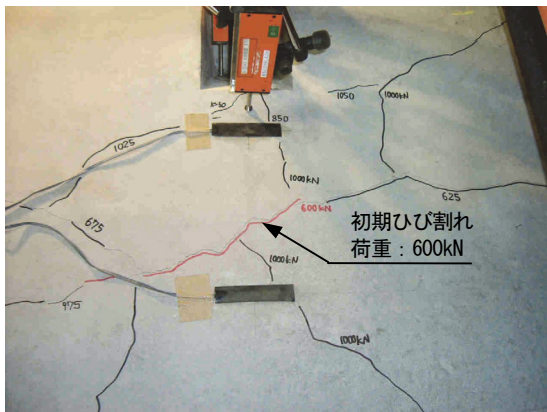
供試体上面のひび割れ発生状況 (本実験)
